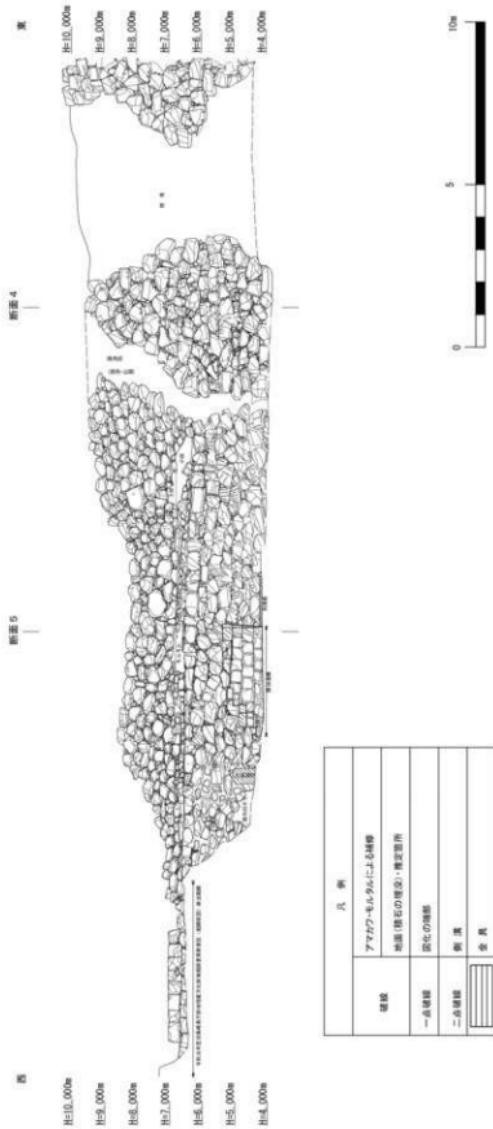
石垣 1 立面図及び断面図 ($S=1/250$)
